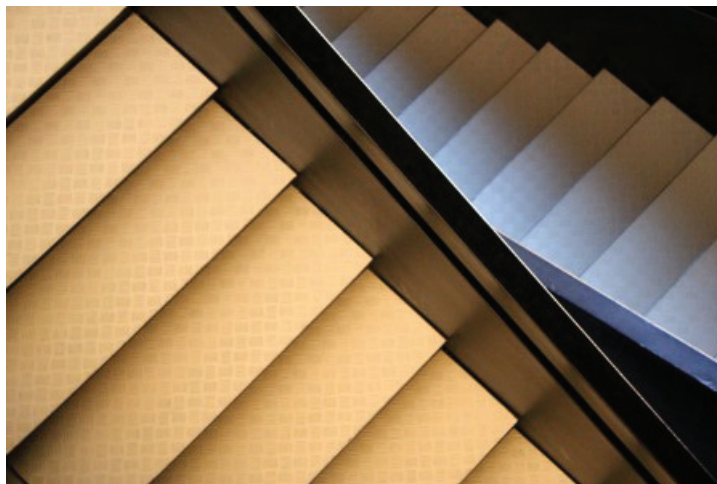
Escadas de estrutura metálica e pavimento de borracha.
